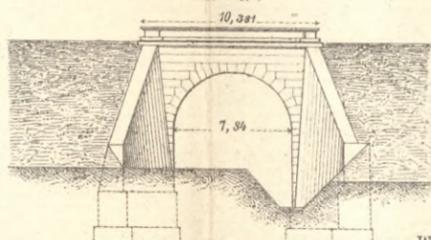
Weg- und Bach-Unterführung der Ensdorfer Kohlenhalde.
